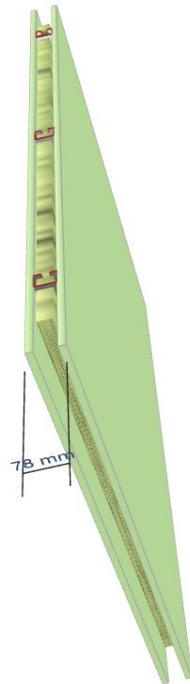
Montante Acero Galvanizado (1.0-1.6mm) INSUL
